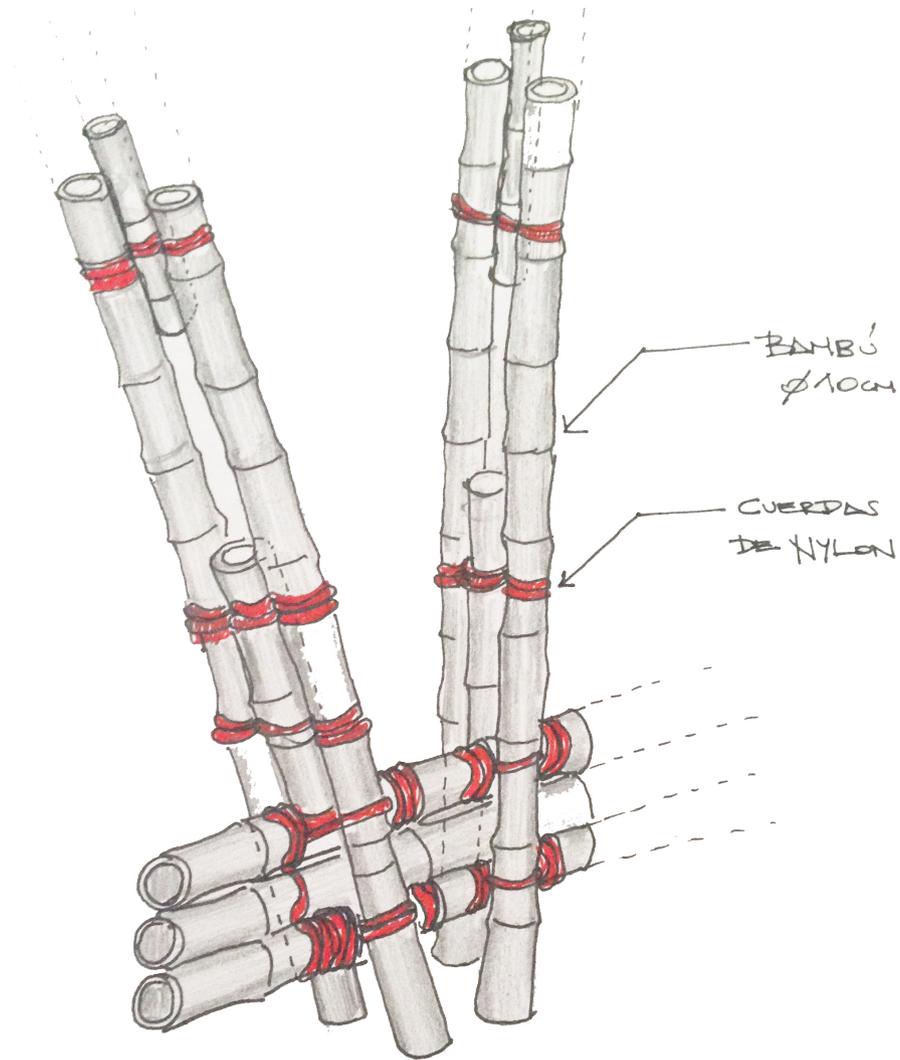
Boceto en el cual se analiza el armado de las vigas compuestas. Vigas principales perimetrales. (Fuente: elaboración propia).
